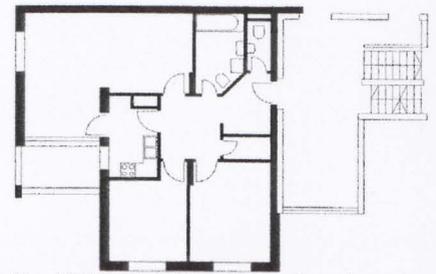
Block C Grundrisse, Angerbauer/Stummer
